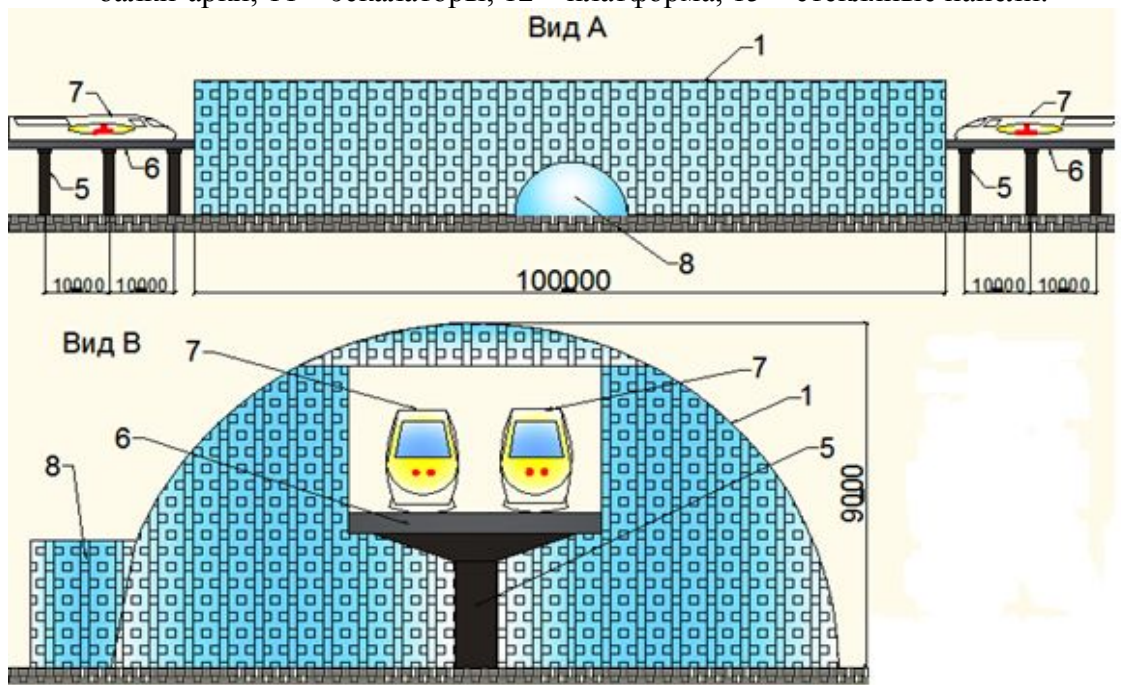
Фасады станции: 1 – здание станции, 5 – опоры пролетного строения, 6 – пролетное строение, 7 – подвижной состав, 8 – gate.
